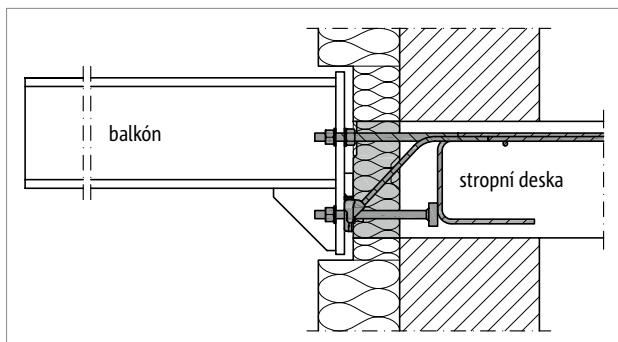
Schöck Isokorb® T typ SKP: Volně vyložený balkón
